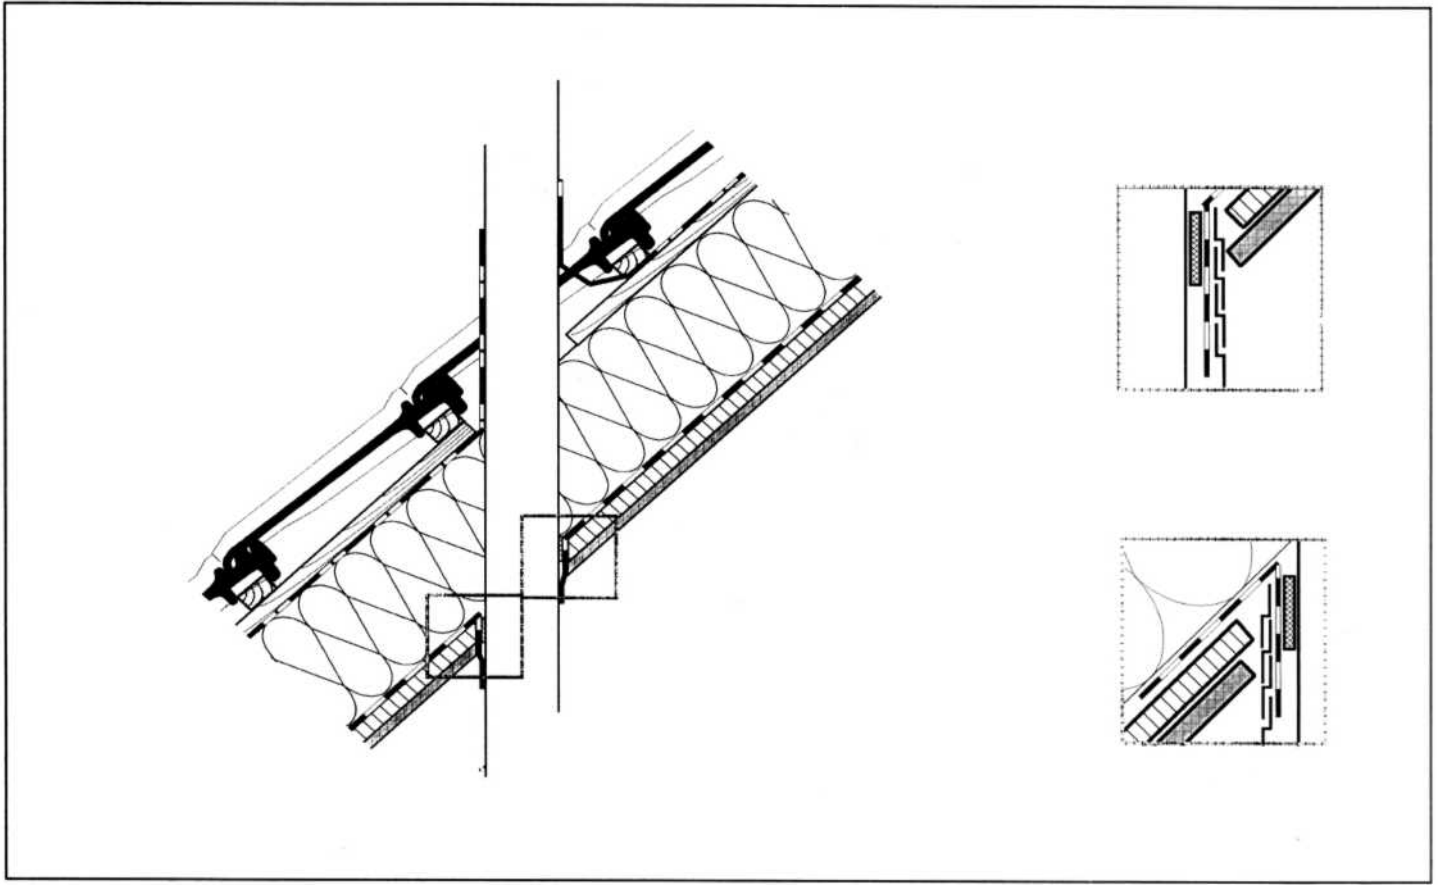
Rohrdurchdringung für die Dachkonstruktion D 1.
